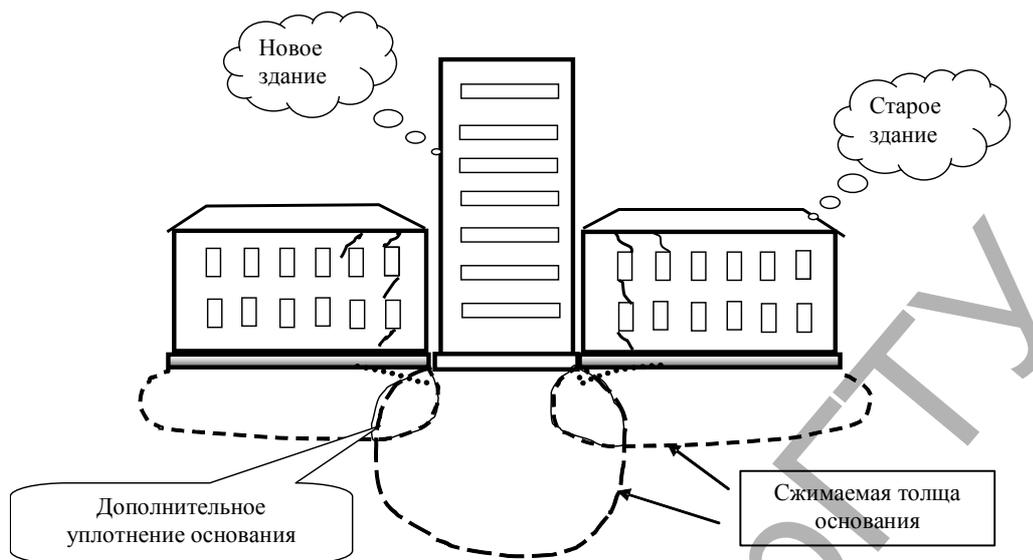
Влиянием загрузки соседних фундаментов
